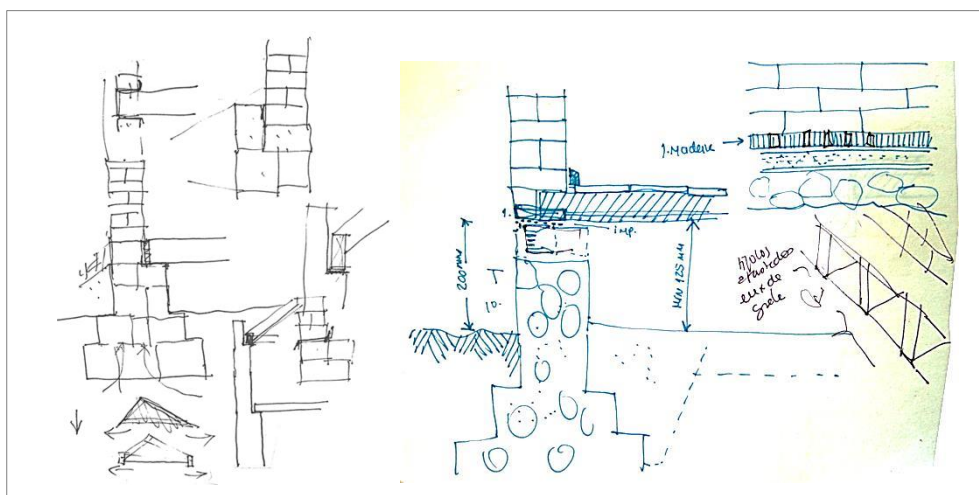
| PORMENORES CONSTRUTIVOS. ESTRUTURA
